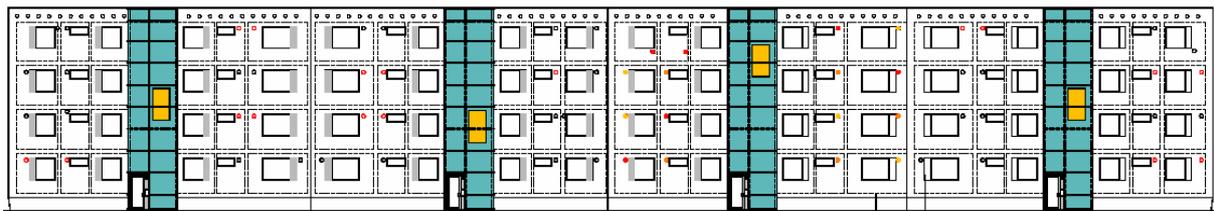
Planung Sanierung Ansicht Nord mit Liftzubau
